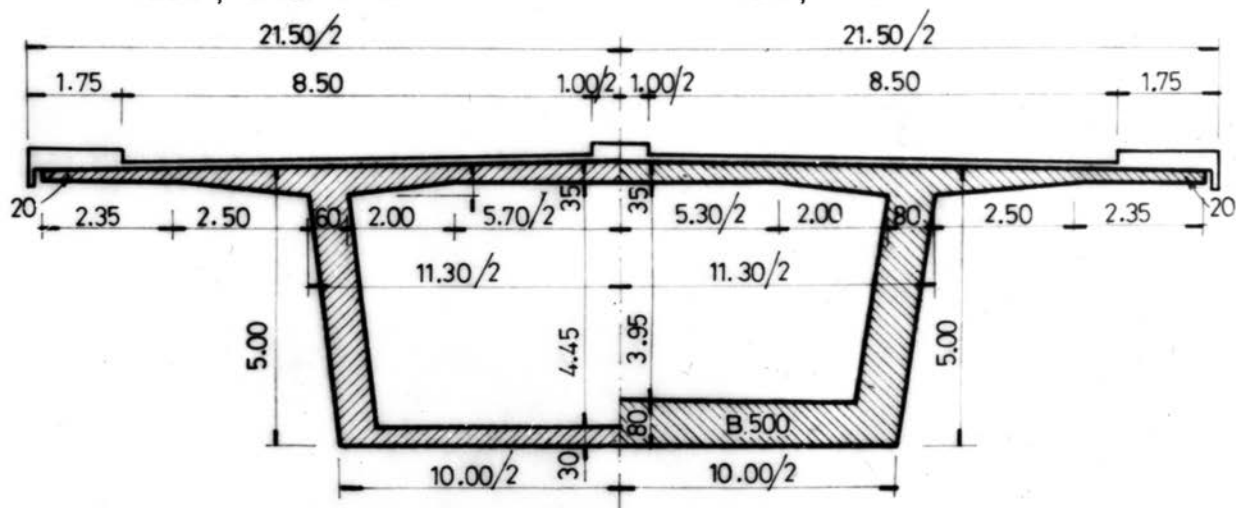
Pod albia minoră. Cadru din beton armat precomprimat cu deschideri de 100 m
